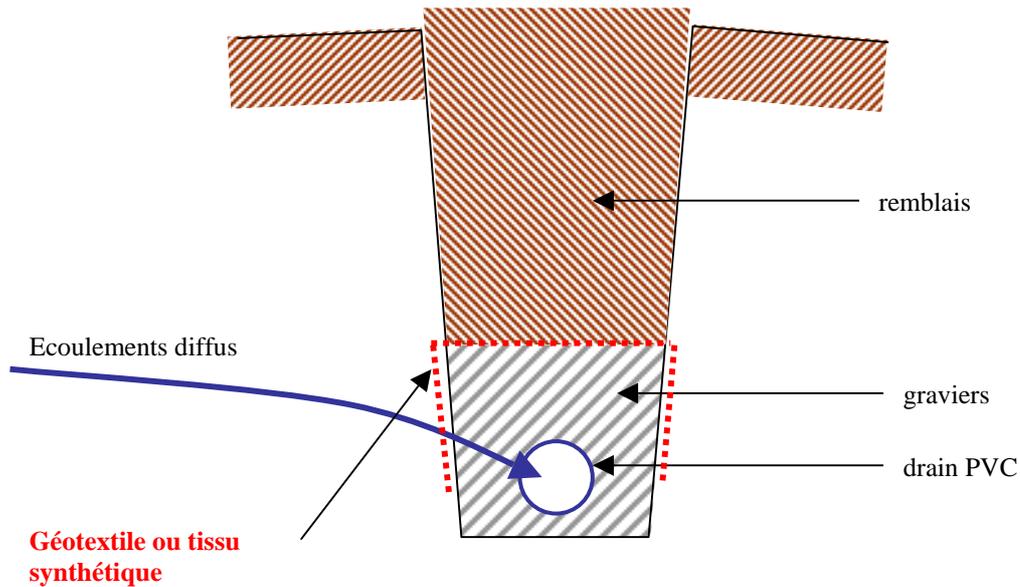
coupe transversale d'un drain au niveau d'une ailette
